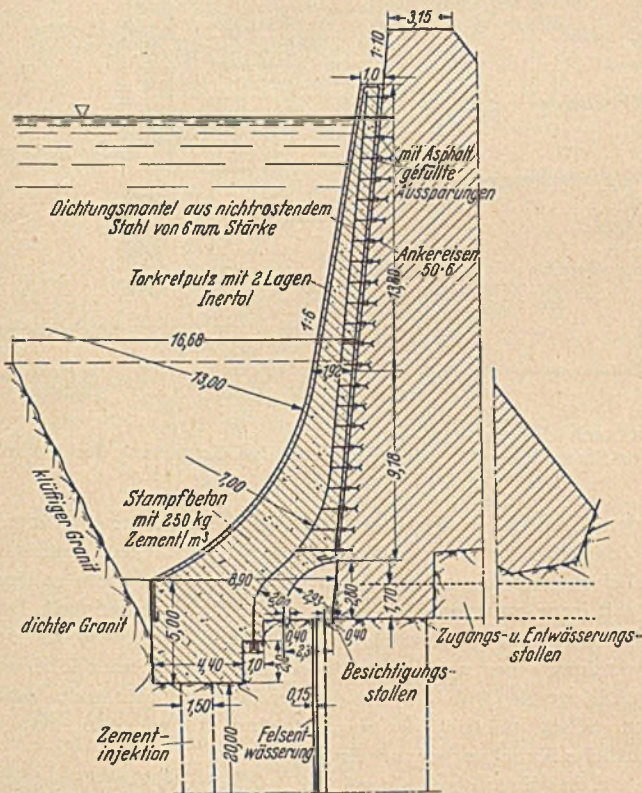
Bruchsteinmauer mit Stahldichtungsmantel.
